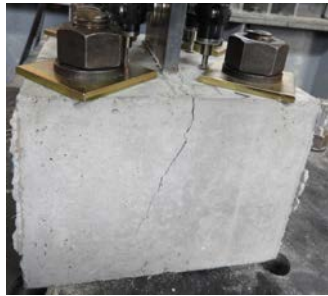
引抜き試験体のモルタルブロック表面のひび割れ
